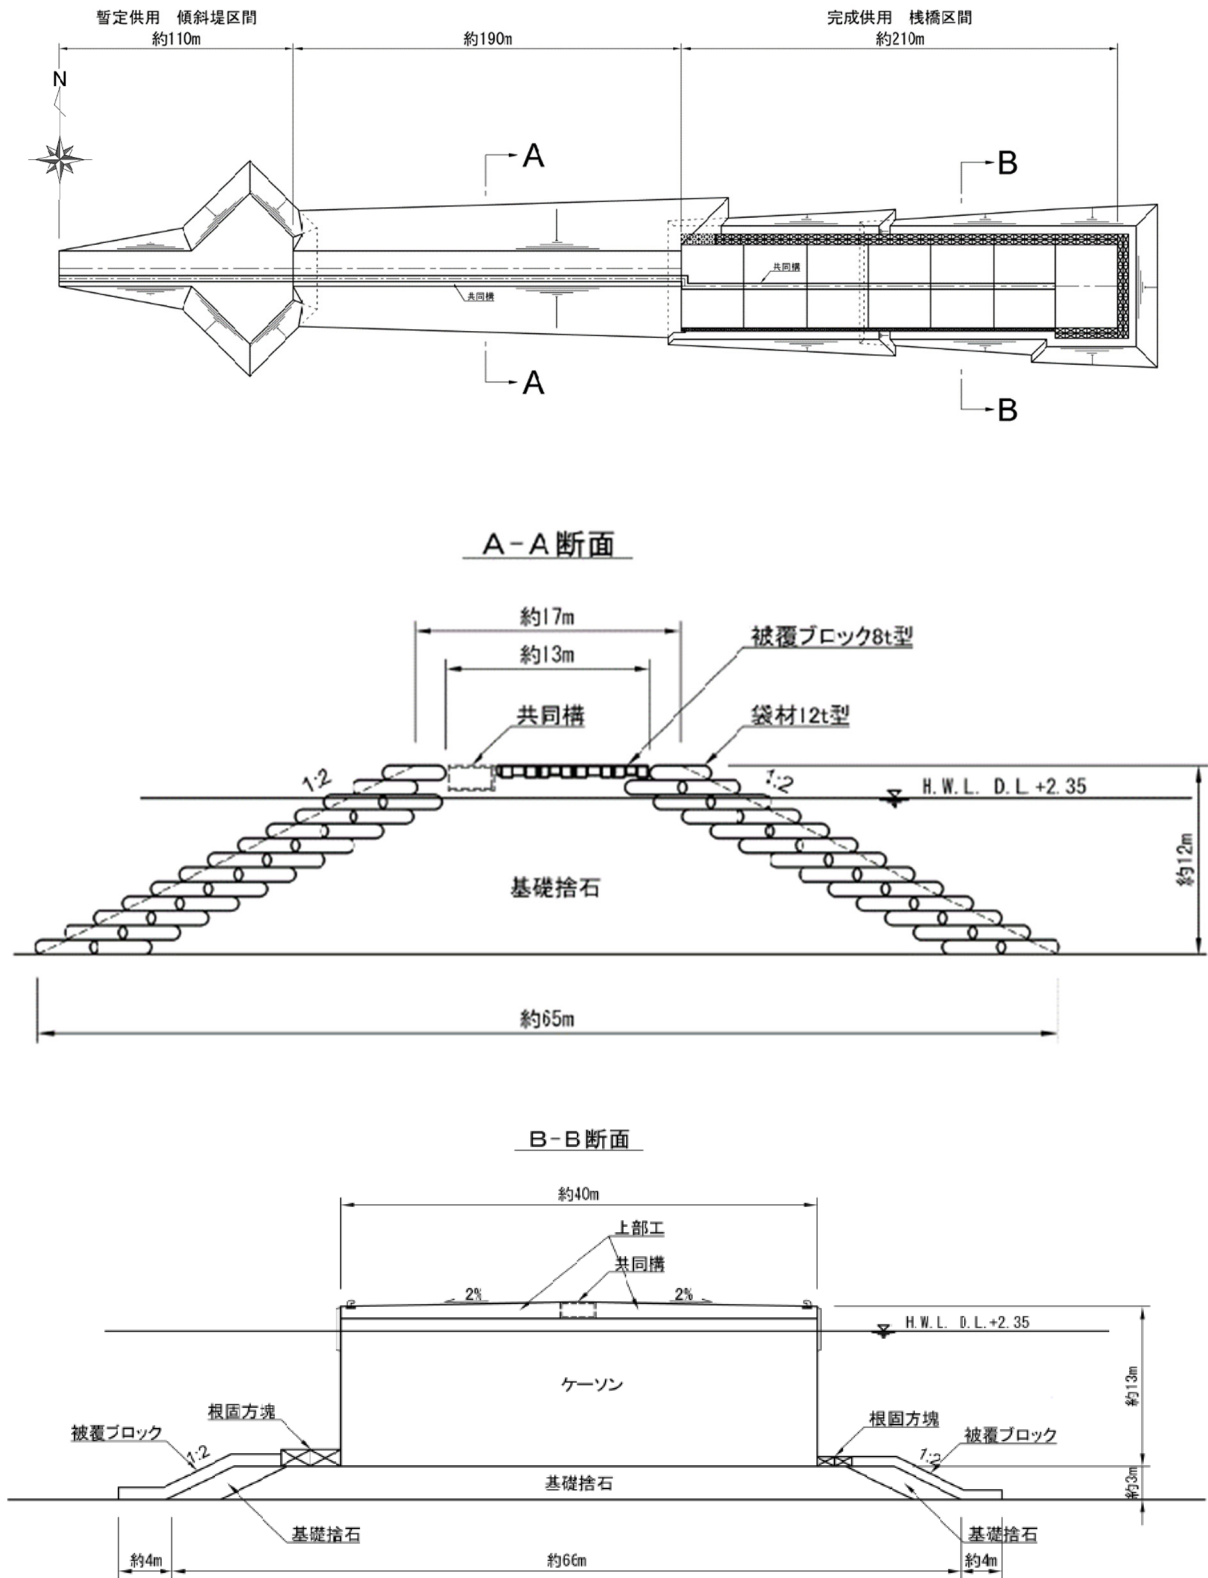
(1) 仮設栈橋の平面図及び標準断面
